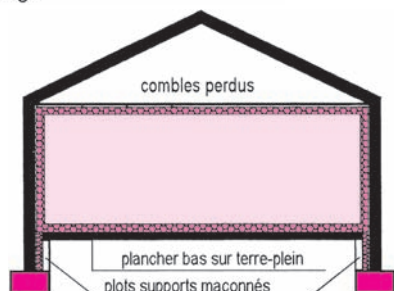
Schéma de principe de l'isolation thermique plancher bas – murs extérieurs – plafond
